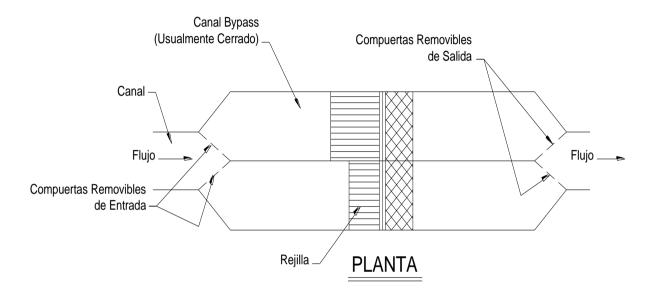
Diseño típico de una reja manual. Vista en planta.
